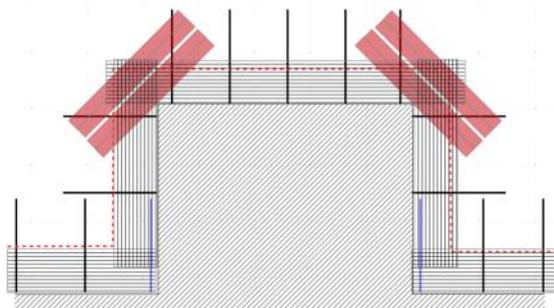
Esempio di distribuzione planimetrica e soluzione in presenza di angoli
